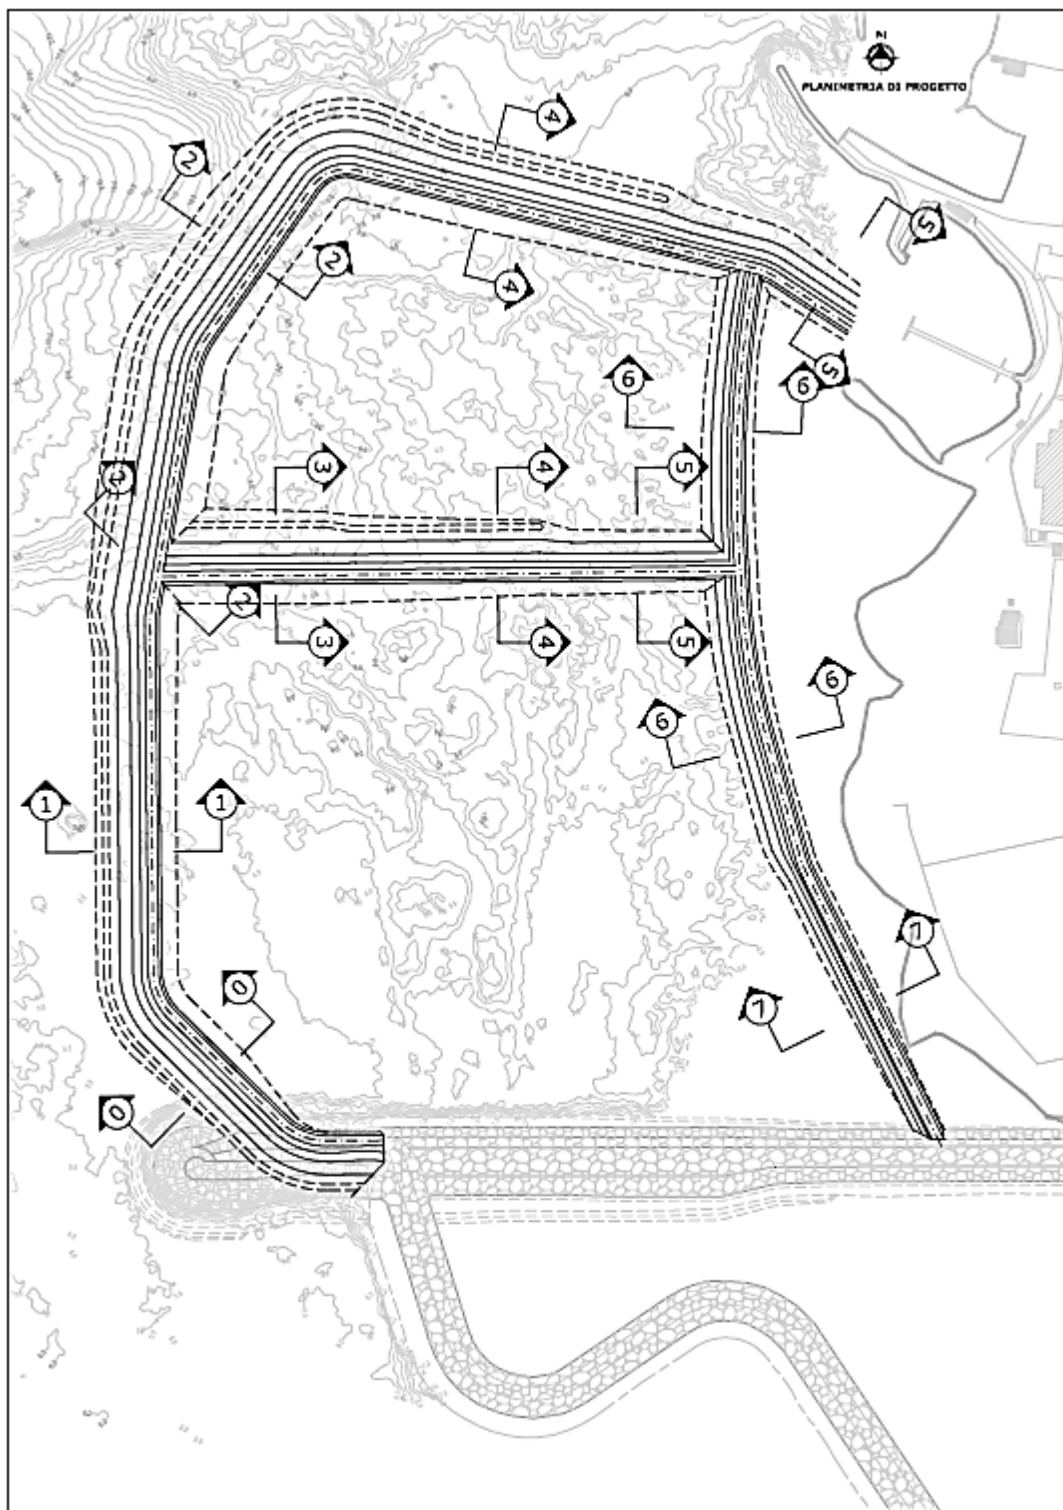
Planimetria di progetto con indicazione sezioni tipo
